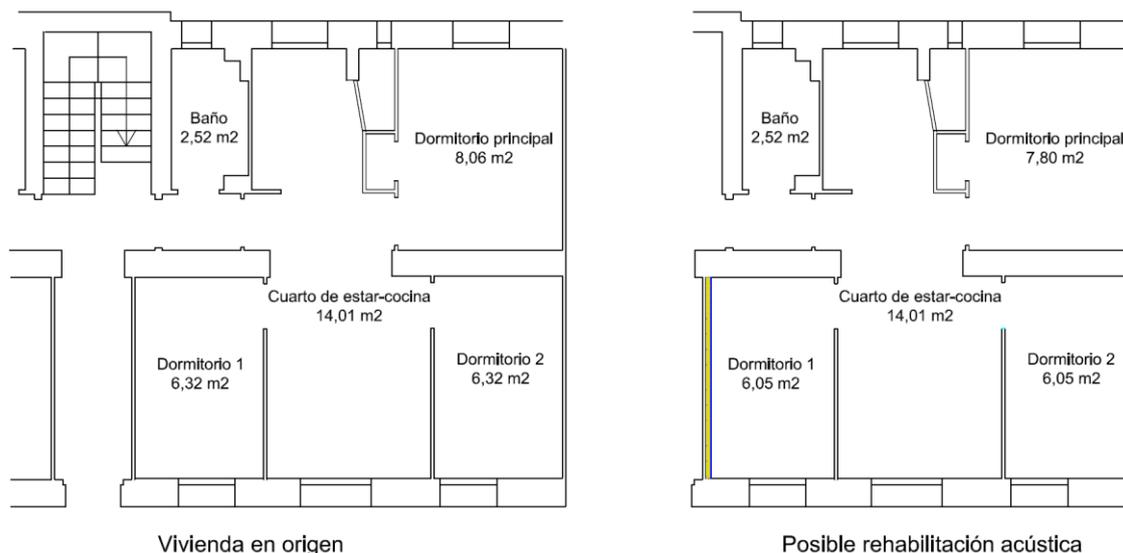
Planta viviendas del Grupo Girón Fase 2 de Zaragoza. Origen y posible rehabilitación por motivos acústicos.
